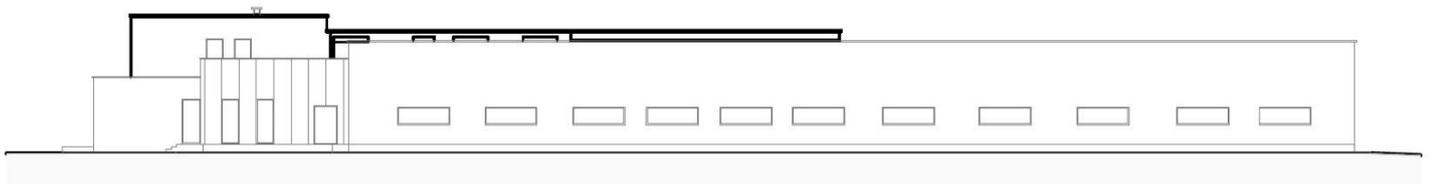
Prospetto Ovest. Scala 1:500. Fonte Bottega Veneta
